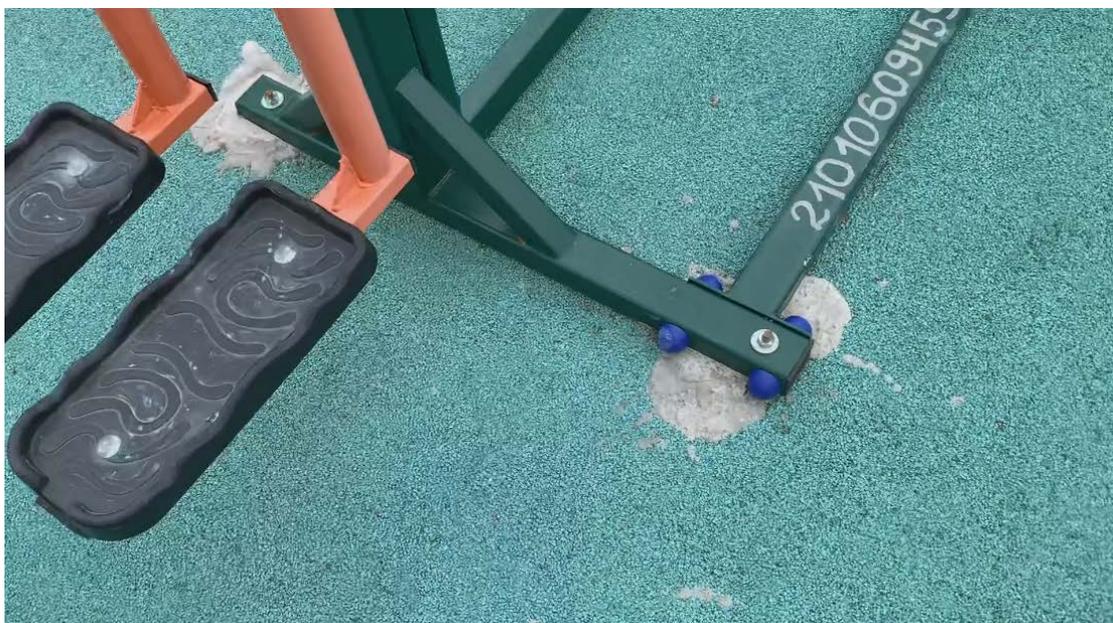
Крепление опорной конструкция тренажерного комплекса к закладным деталям фундамента смонтированного на площадке №2 у тренажера для сведения ног. Места примыкания универсального покрытия к блоку фундамента залиты цементным раствором поверх универсального покрытия.
